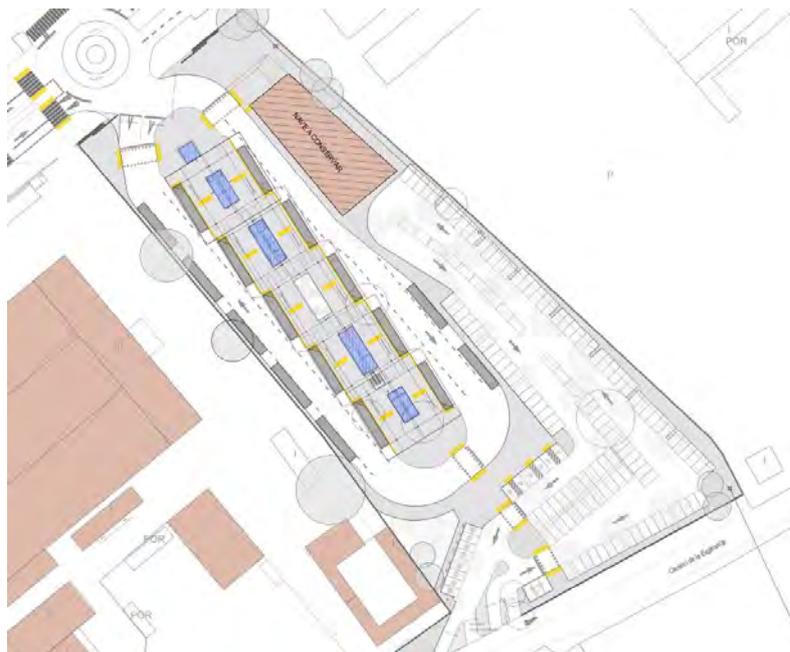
Planta general del anteproyecto de la estación. Fuente: DG de Infraestructuras de Transporte Colectivo
